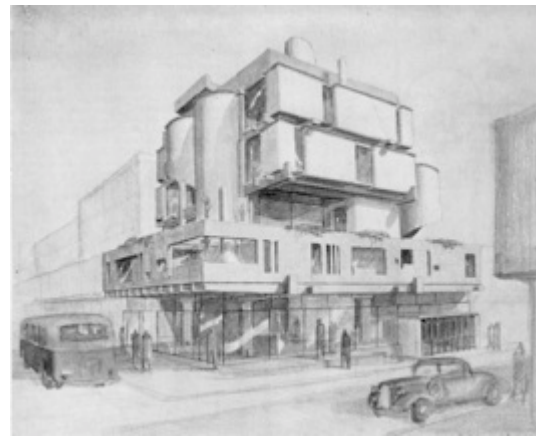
Estudio Geométrico de Fachadas. Fuente Revista Proa No. 143
